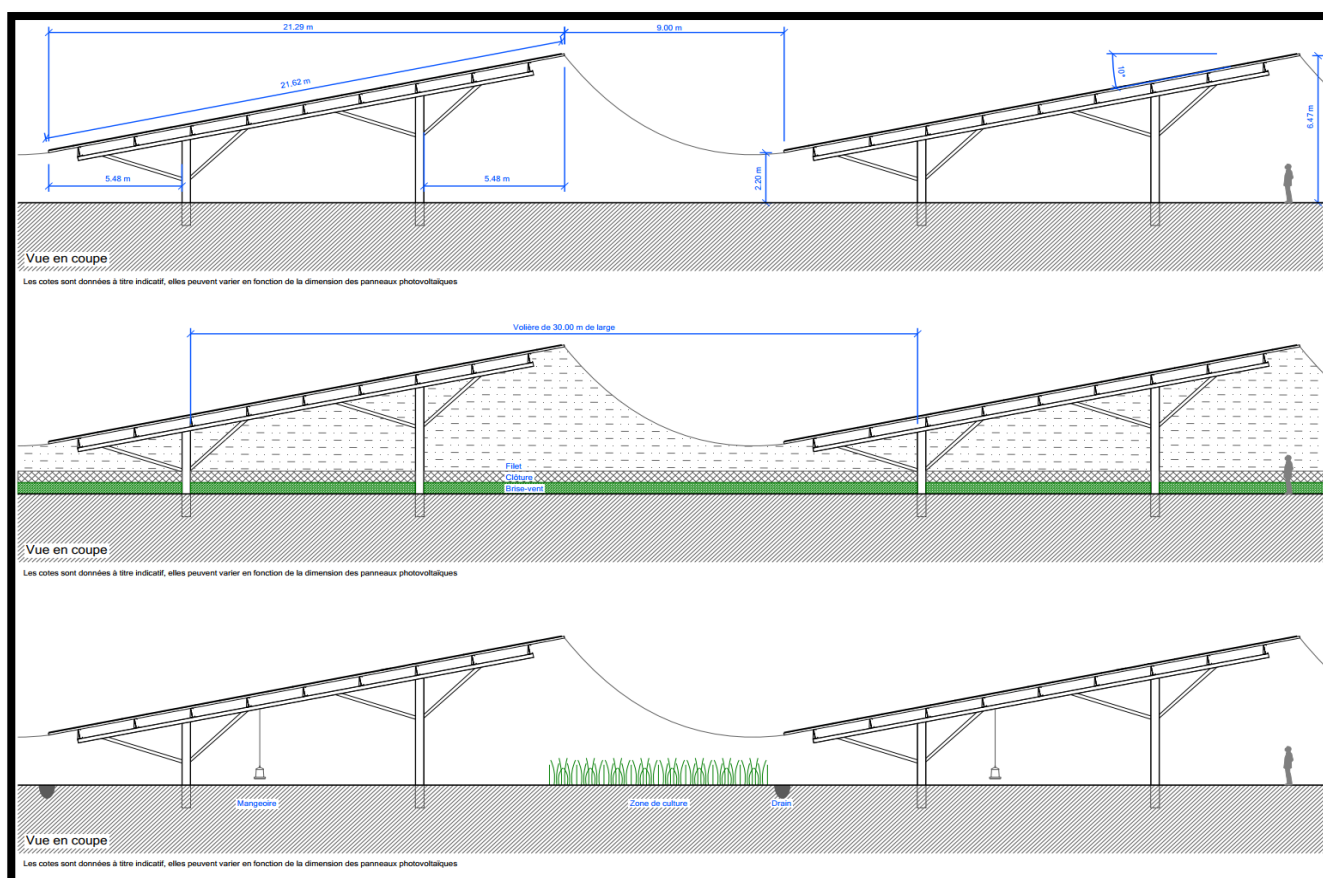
Plan de coupe d'ombrières bi-pieux (schéma de principe)
